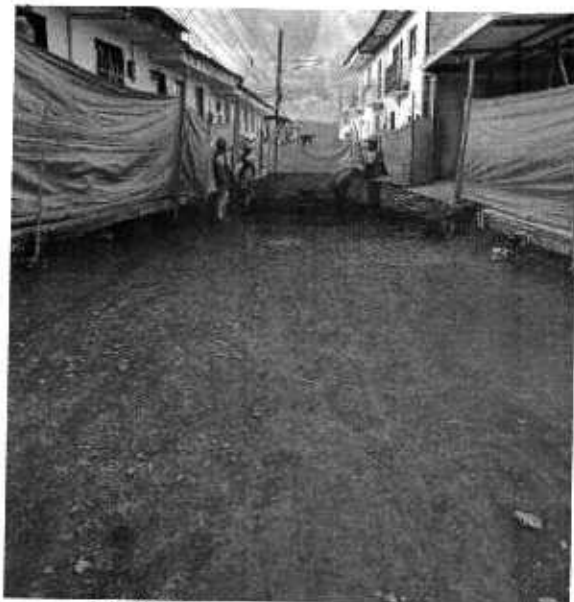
Excavación para nivelar base del pavimento Foto N° 12: Excavación para cajas de domiciliarias
